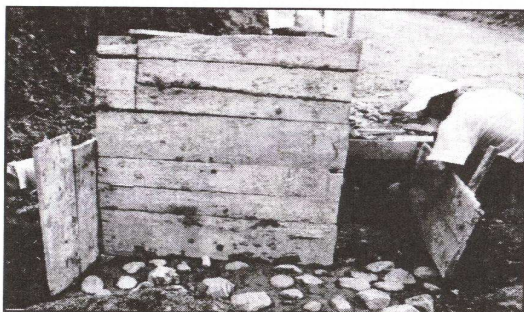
Proceso de llenado de la formaleta con concreto ciclópeo
